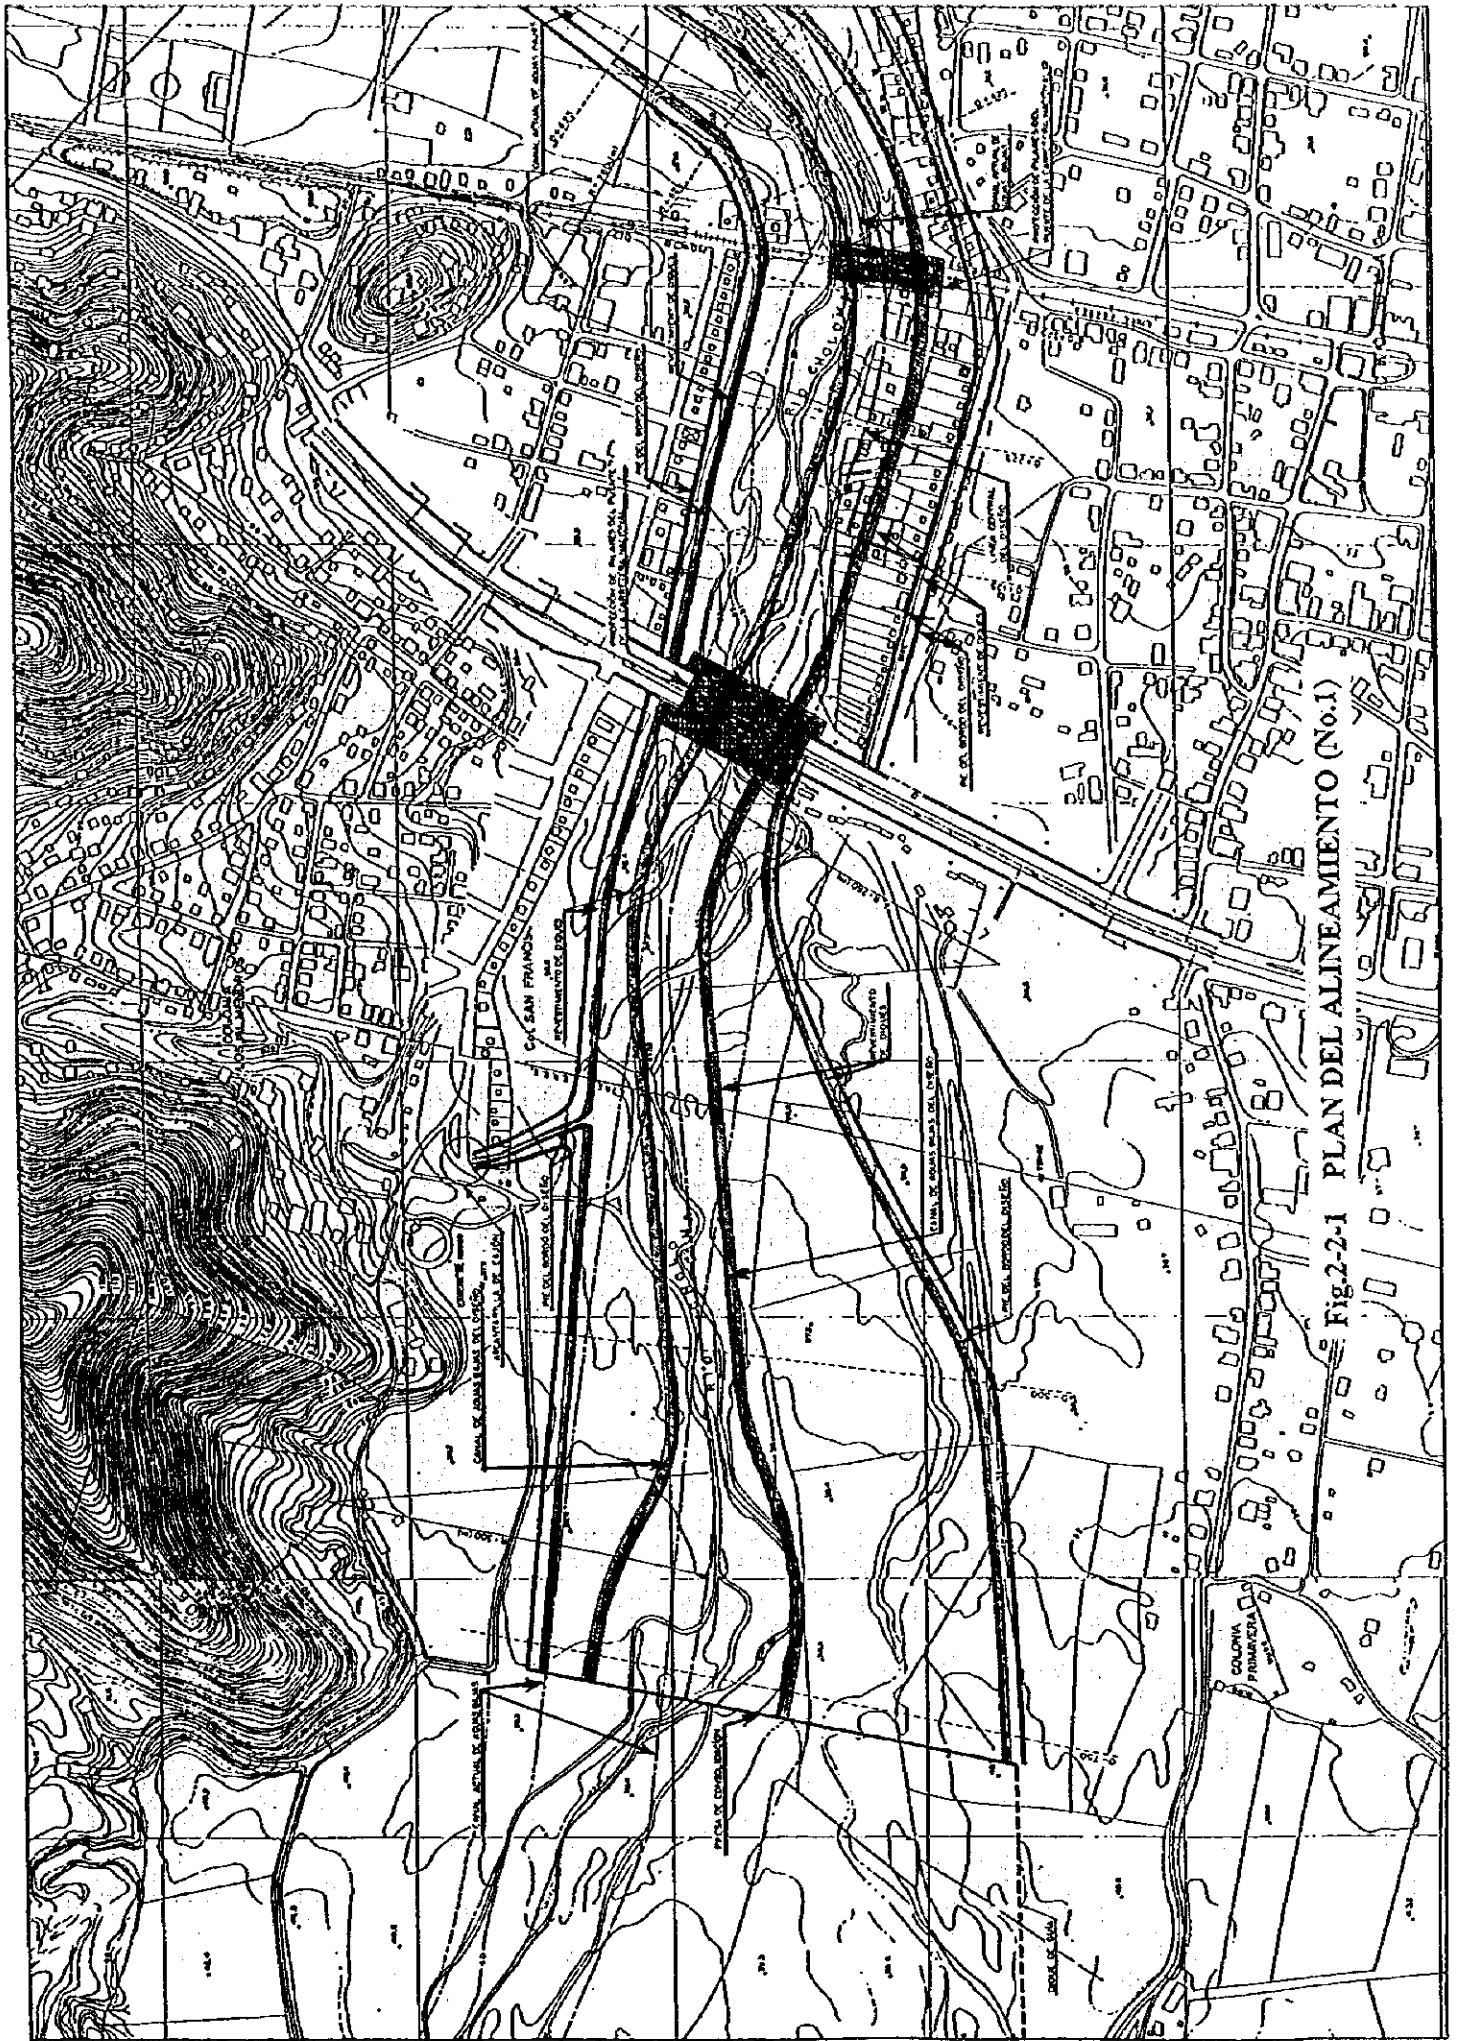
PLAN DEL ALINEAMIENTO (No.1)
